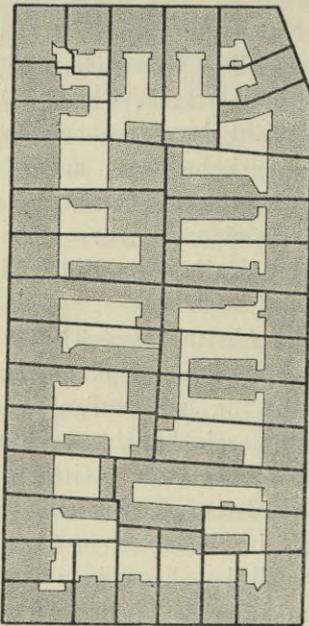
Bebauung mit Hinterflügeln. Block von der Seckenheimer Straße in Mannheim.
